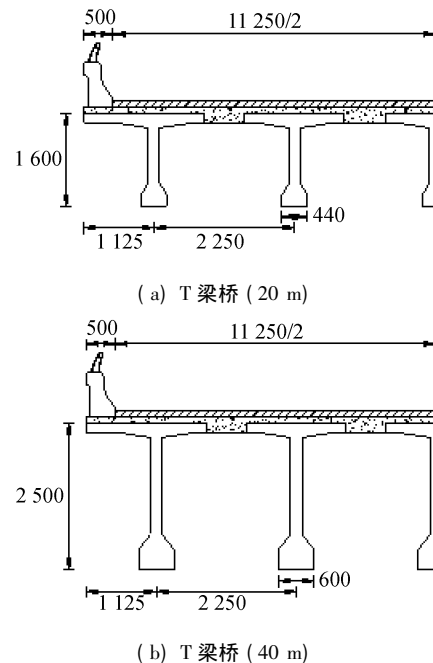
桥梁跨中 1/2 横断面图 (单位: mm)
